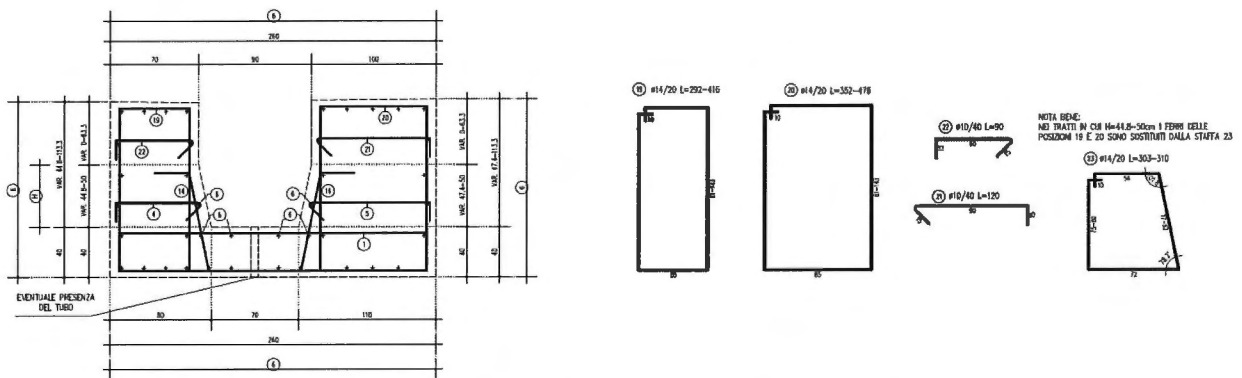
Schema armatura - Sezione Tipo E (Barriera Doppia) – Tratto 4 e 5
